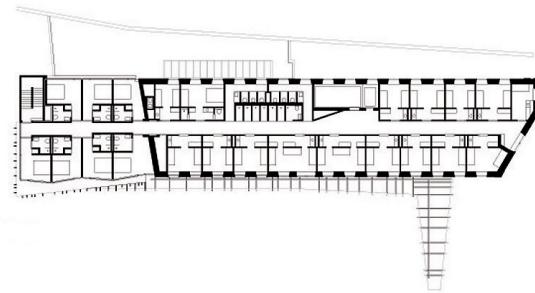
Grundriss OG Jugendherberge St. Alban
